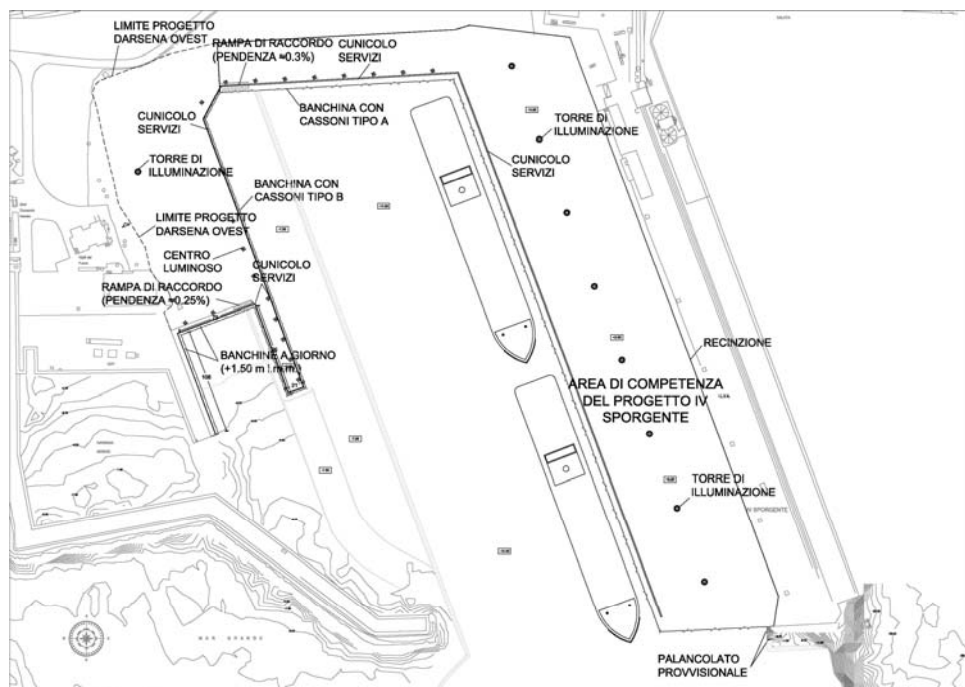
Planimetria degli interventi previsti nella Darsena e nell'ampliamento del IV sporgente
